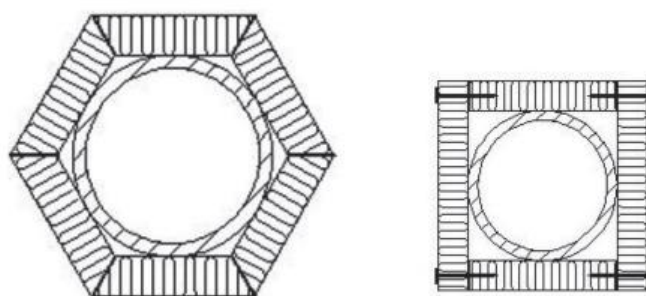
Схема покрытия на балках и колоннах круглого сечения [1]
